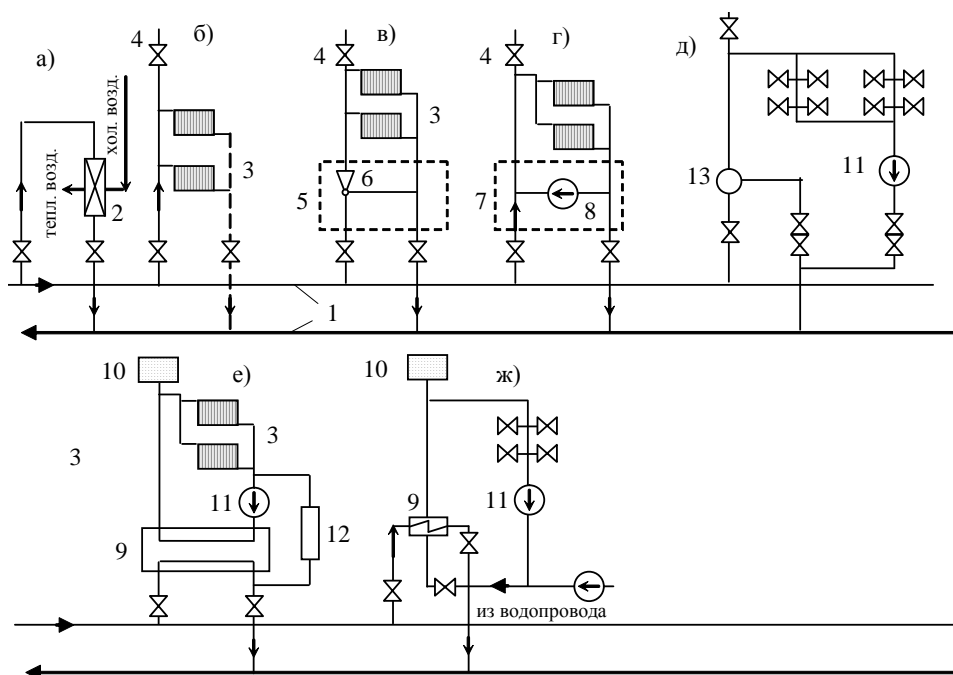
Присоединение местных систем теплopotребления к тепловым сетям без понижения (непосредственное) (а-б) и с понижением потенциала (в-е): 1 – подающий и обратный трубопроводы тепловой сети; 2 – калорифер вентиляции; 3 – местная система отопления; 4 – воздушник; 5 – элеваторный смесительный узел; 6 – элеватор; 7 – насосный смесительный узел; 8 – подмешивающий насос; 9 – поверхностных теплообменник отопления; 10 – расширительный сосуд; 11 – циркуляционный насос; 12 – подпиточное устройство; 13 – смеситель
